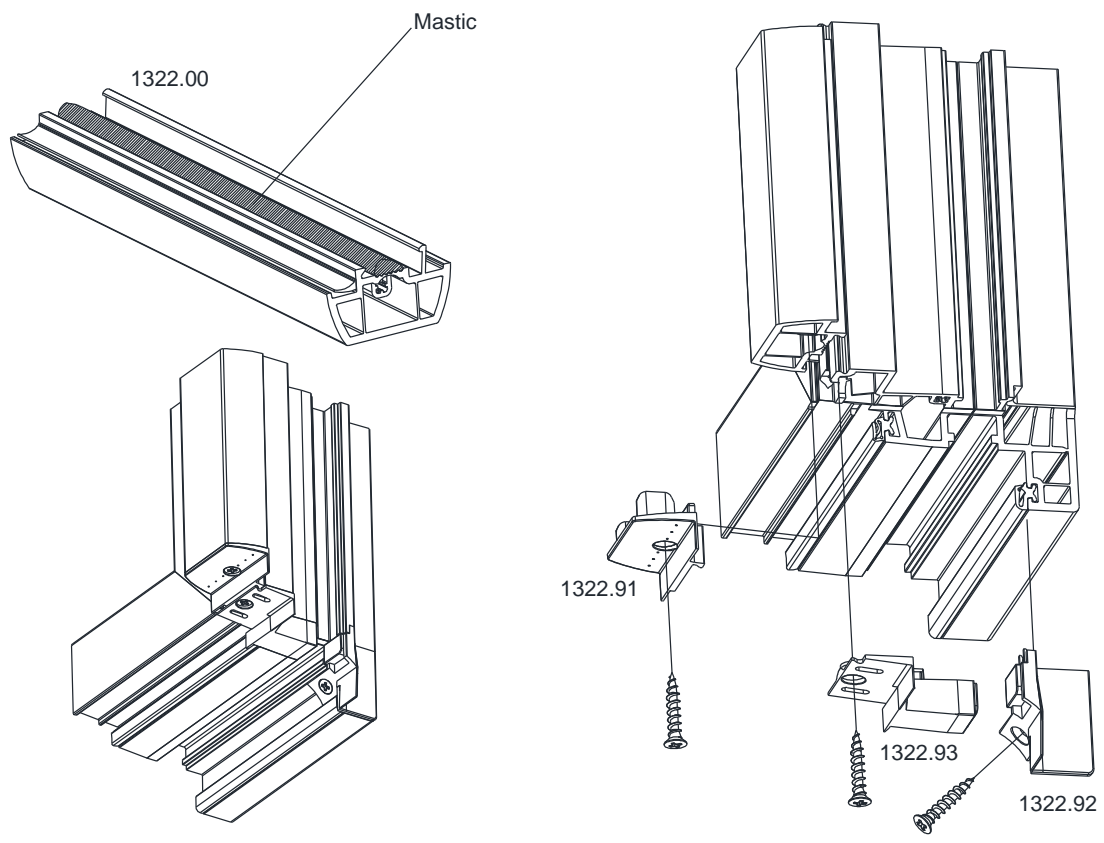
DETAIL ASSEMBLAGE SYSTEME DE DOUBLAGE
